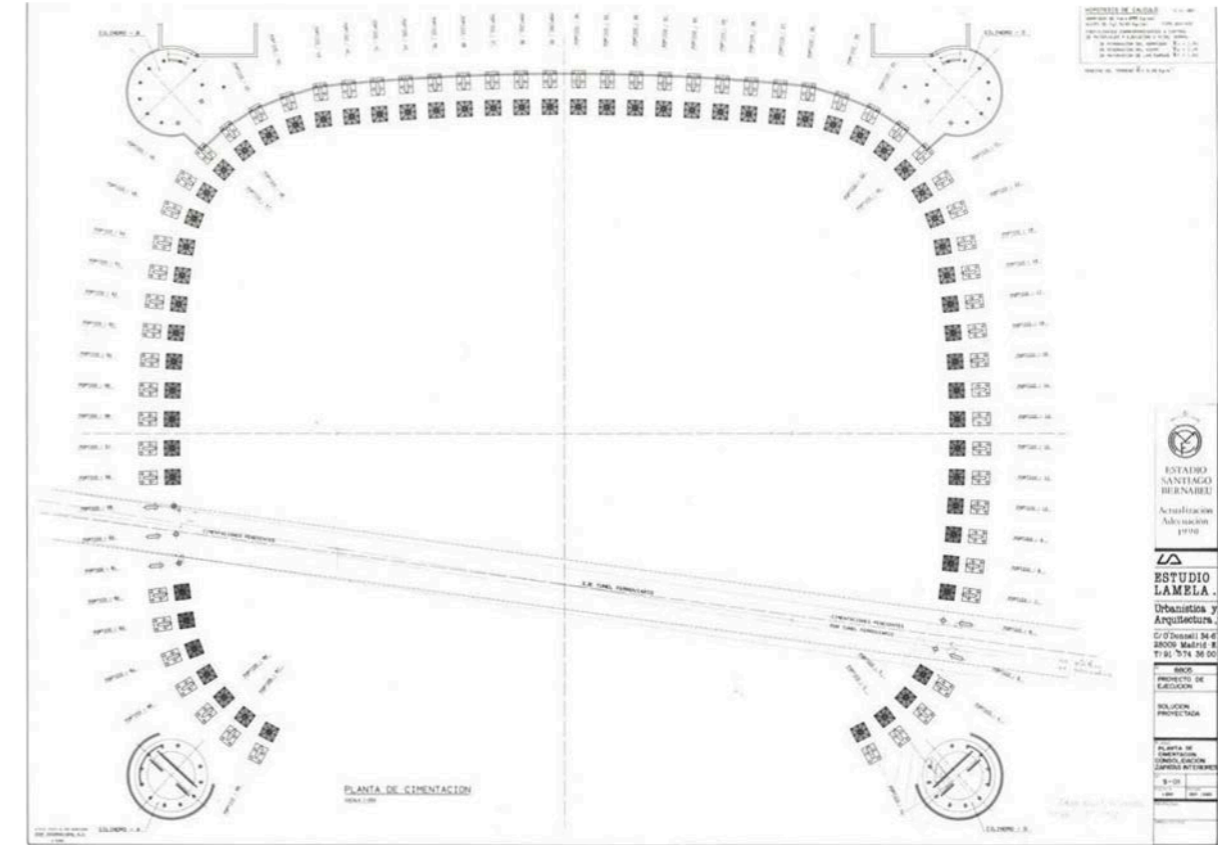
Planta de cimentaciones elaborada para la reforma de 1992.
